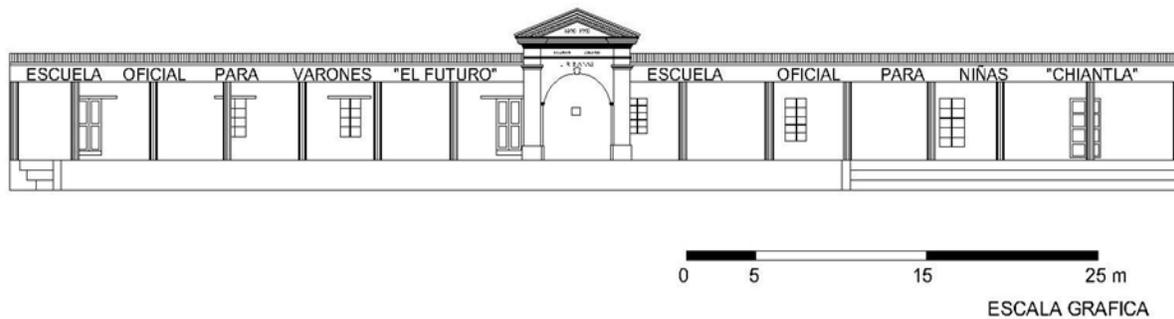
Fachada principal: En donde se aprecia en la parte central un frontón triangular y dos pilastras con un arco de tres centros, con un corredor central y columnas cilíndricas. Elaboró: Mauricio Sosa.
